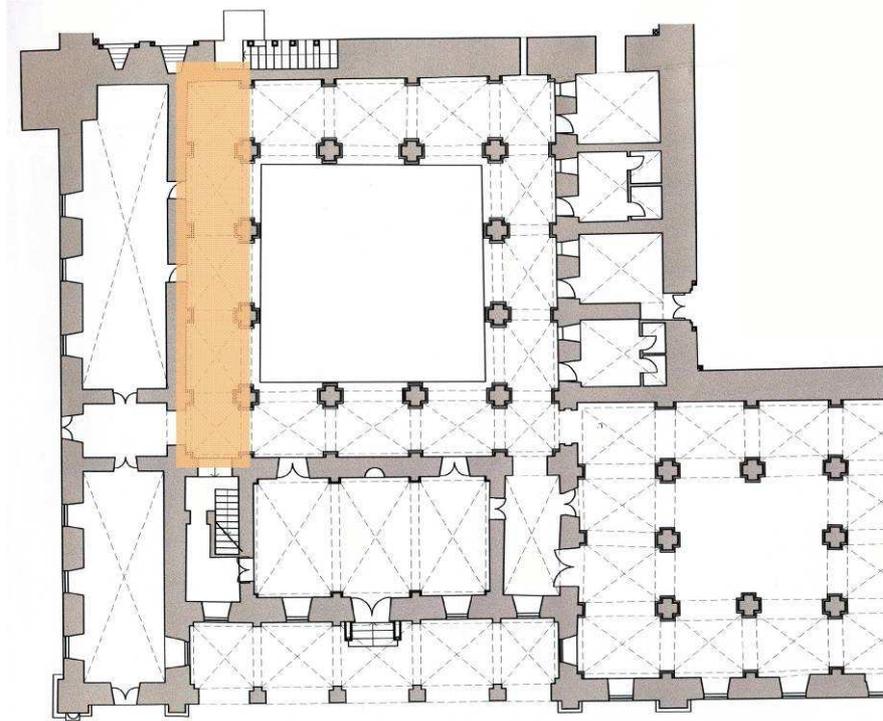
Localização da galeria Norte na planta do piso térreo do levantamento de 2003.
